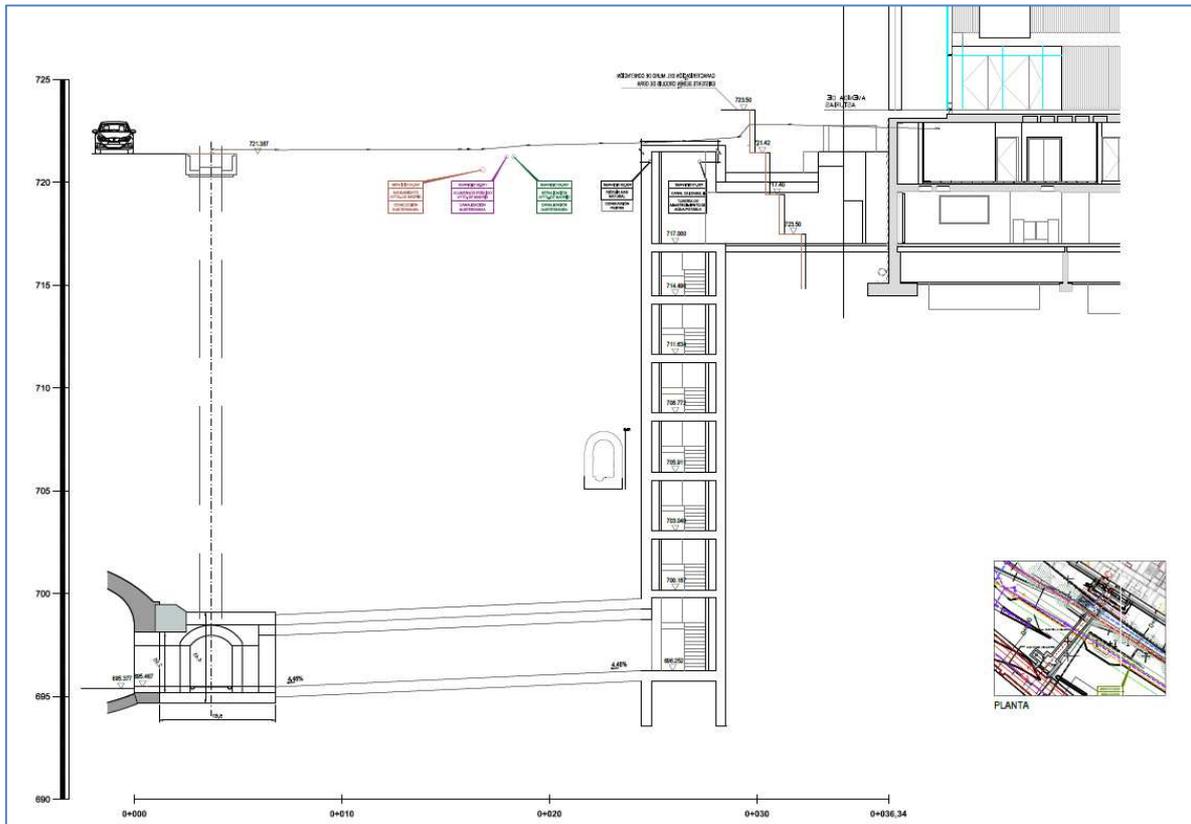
Sección de galería Línea 9 – Edificio 1.
